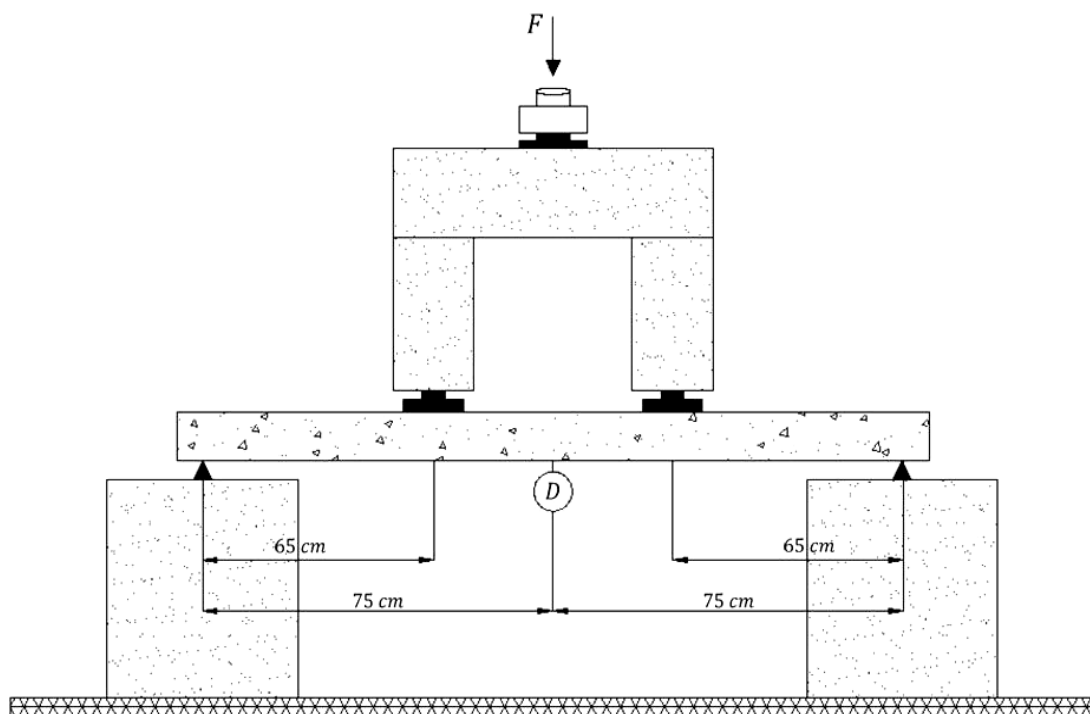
Representação esquemática do ensaio das lajes (adaptado de Bandeira, 2006).
